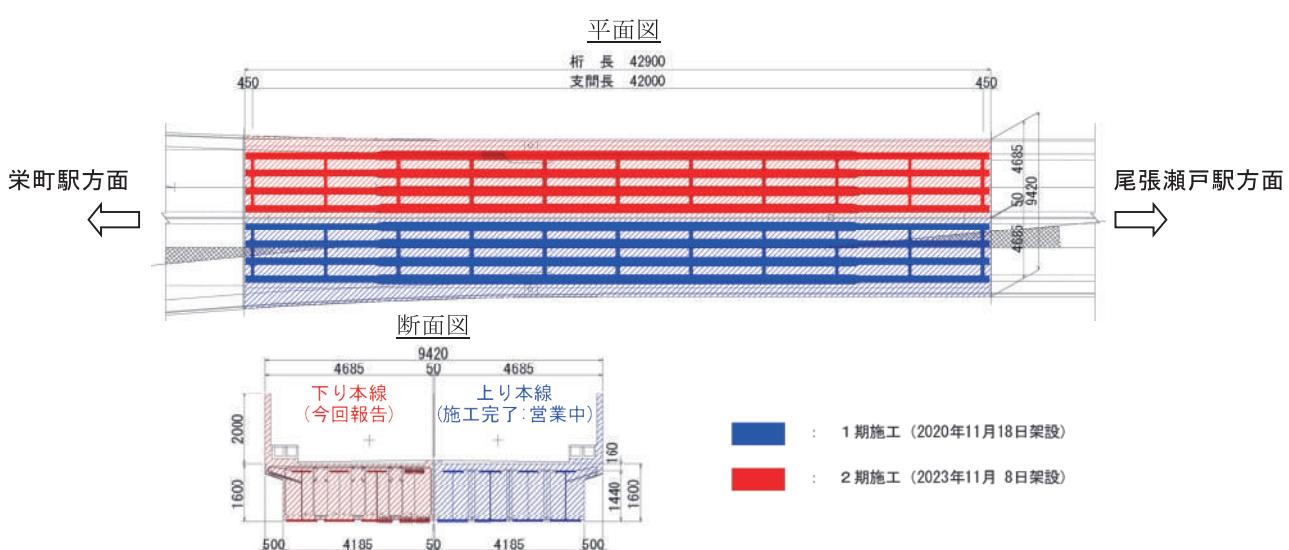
H 型鋼埋込桁構造図（平面図、断面図）
